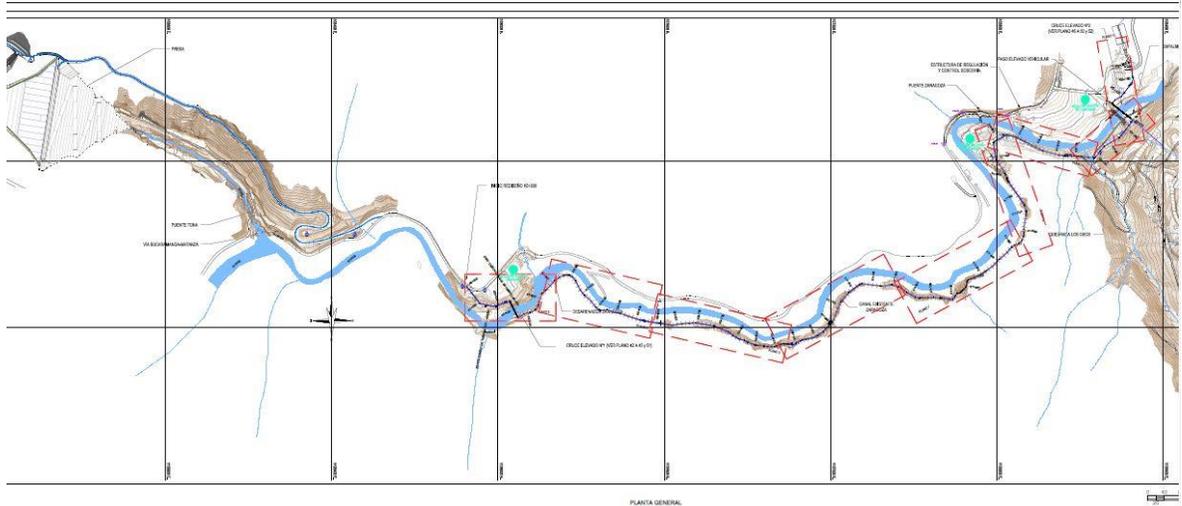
Plano en AutoCAD de la vista en planta de la tubería de aducción. (amb S.A. E.S.P, 2019)
